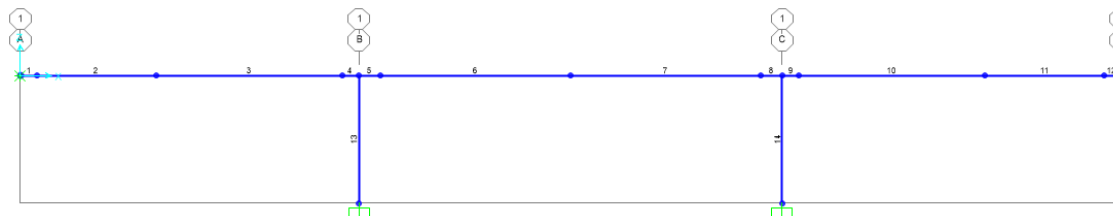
Numeración de barras de la estructura. Vista longitudinal
